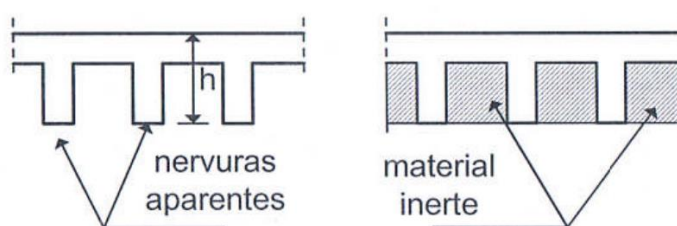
Lajes nervuradas (Fonte: Araújo, 2010)
